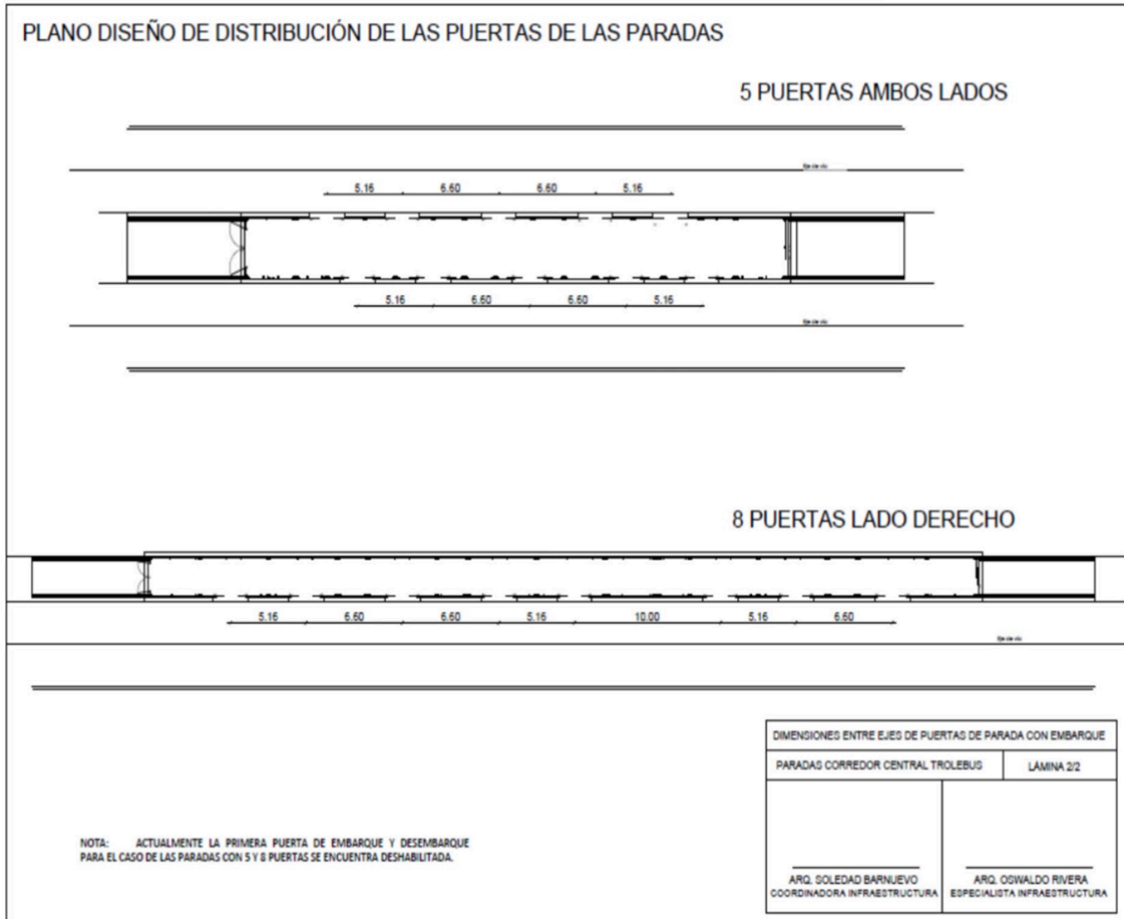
b. Plano de Paradas (estaciones) con 5 puertas ubicadas a ambos lados; y, paradas (estaciones) con 8 puertas ubicadas del lado derecho
